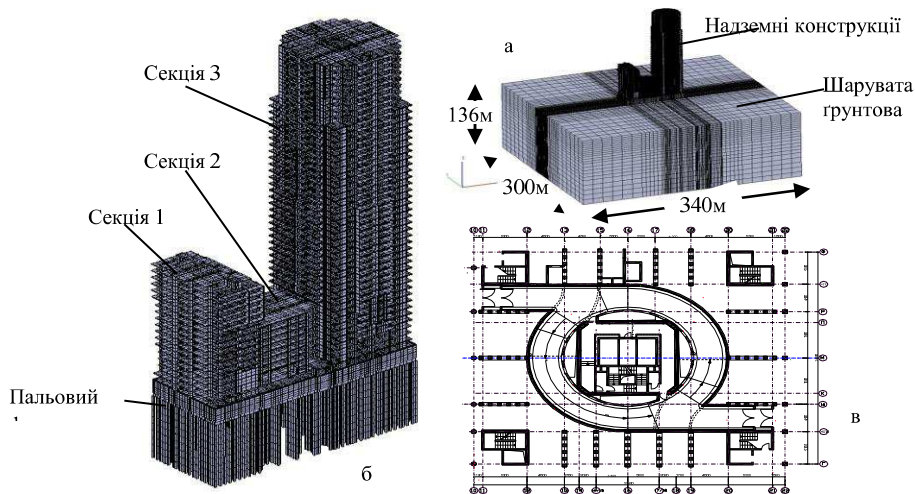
Багатосекційний висотний комплекс: а – скінченноелементна модель будівель як систем «основа – фундамент – будівля»; б – скінченноелементна схема інженерних конструкцій; в – план несучих конструкцій надфундаментного поверху секції № 3
